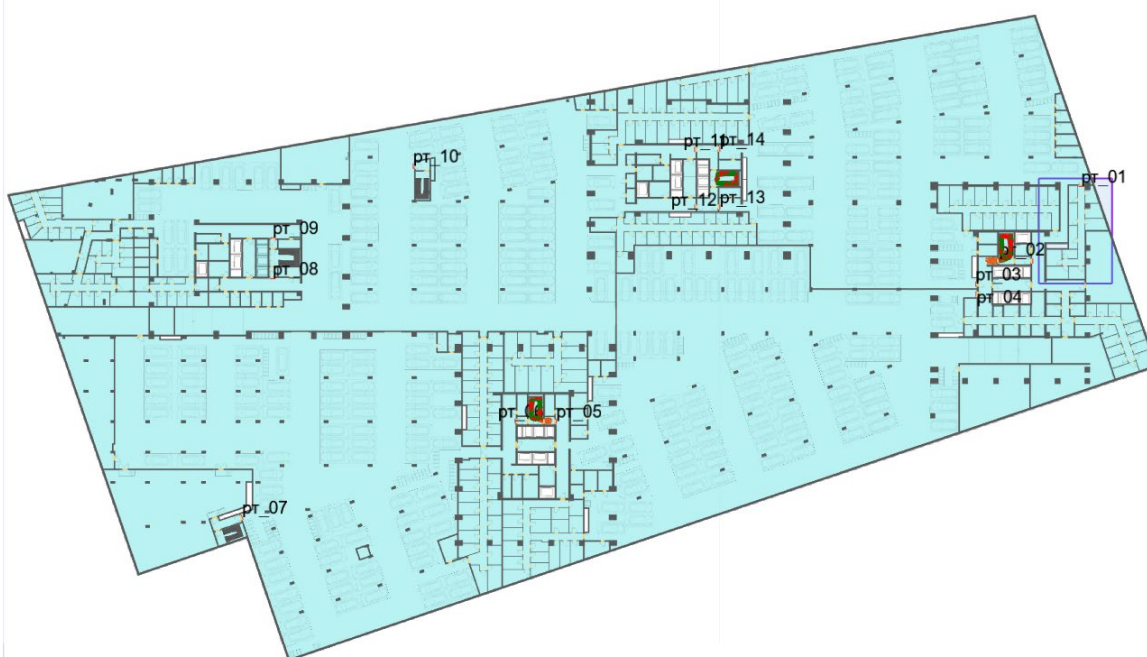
План минус 3-го этажа и нанесенная на него расчетная (принципиальная) схема эвакуации (расположение людей на момент полной эвакуации с этажа пожара – 3 мин.59 сек.)
